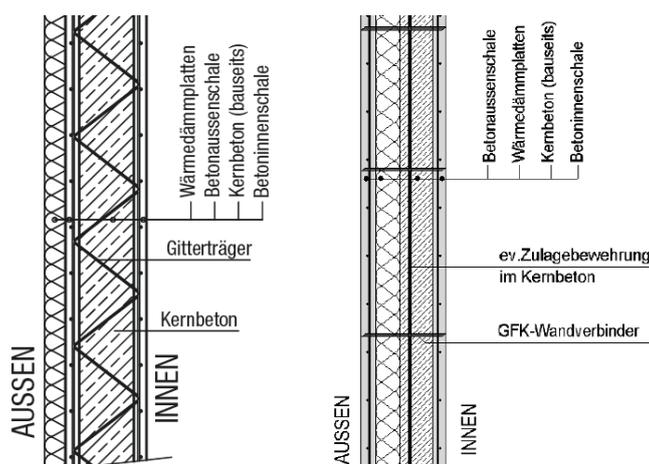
Hohlwandelemente mit werkseitiger Außendämmung (links) und mit integrierter Dämmelemente (rechts) [53]
